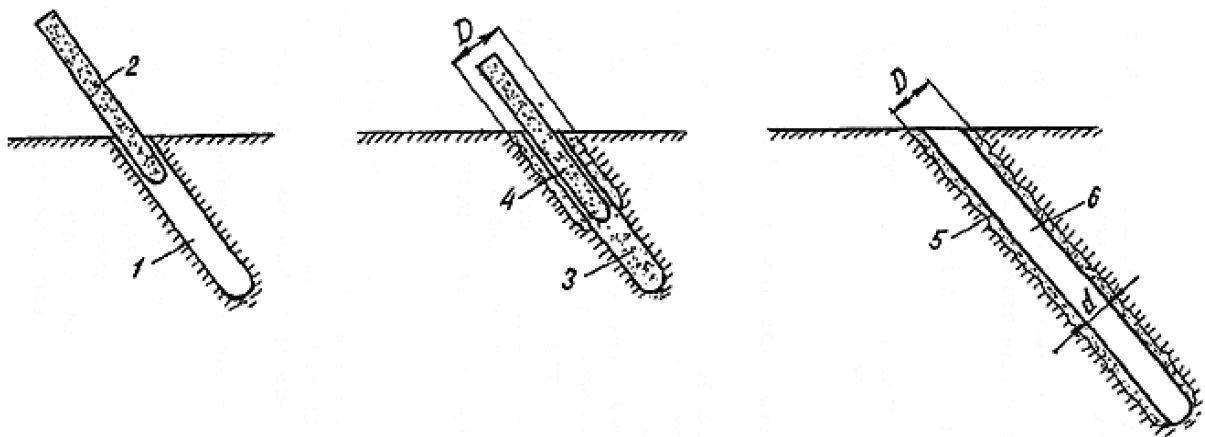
Схема виготовлення щебеневої палі: 1 – свердловина; 2 – пневмопробійник; 3 – щебінь (гравій); 4 – ділянка палі; 5 – готова палля; 6 – внутрішня порожнина палі
